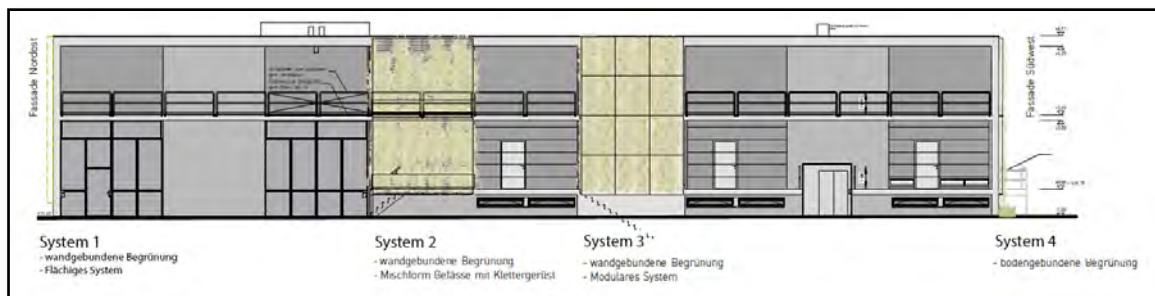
Lage der beispielhaften Fassadenbegrünungen bei der Stadtgärtnerei Zürich. Quelle: Raderschallpartner AG, Erstelldatum: 22.09.16, Plan-Nr. 1065-S-4-4 1065.
